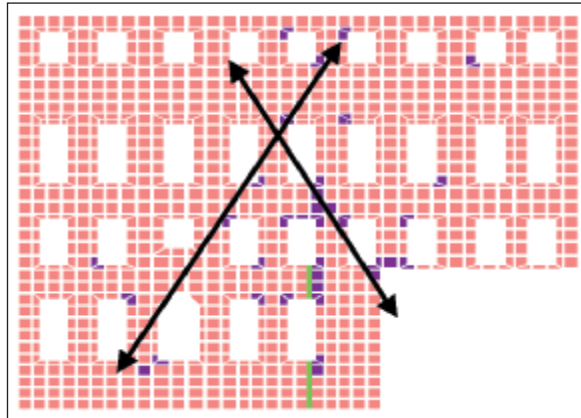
Parete perimetrale Est: elementi con modulo di Young ridotto e linee fessurative.
